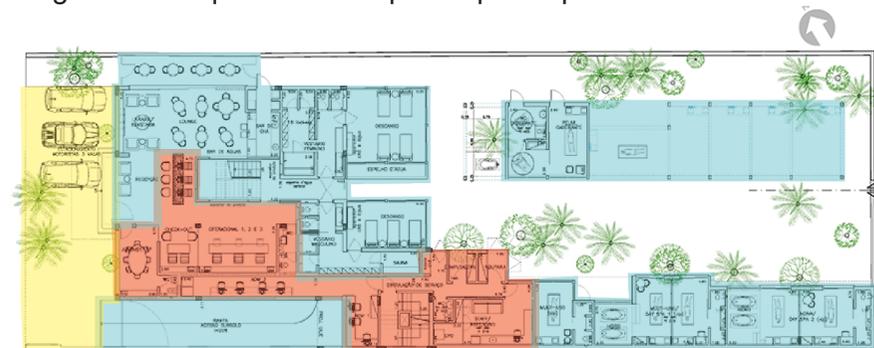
Esquema Hierarquia Espacial planta baixa subsolo
